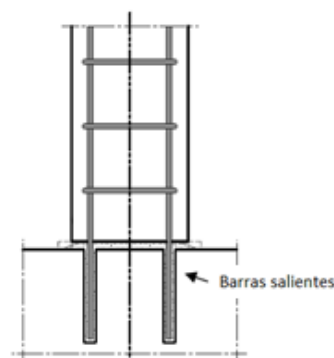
Ligação pilar-fundação. Adaptado: Fib (2014).
